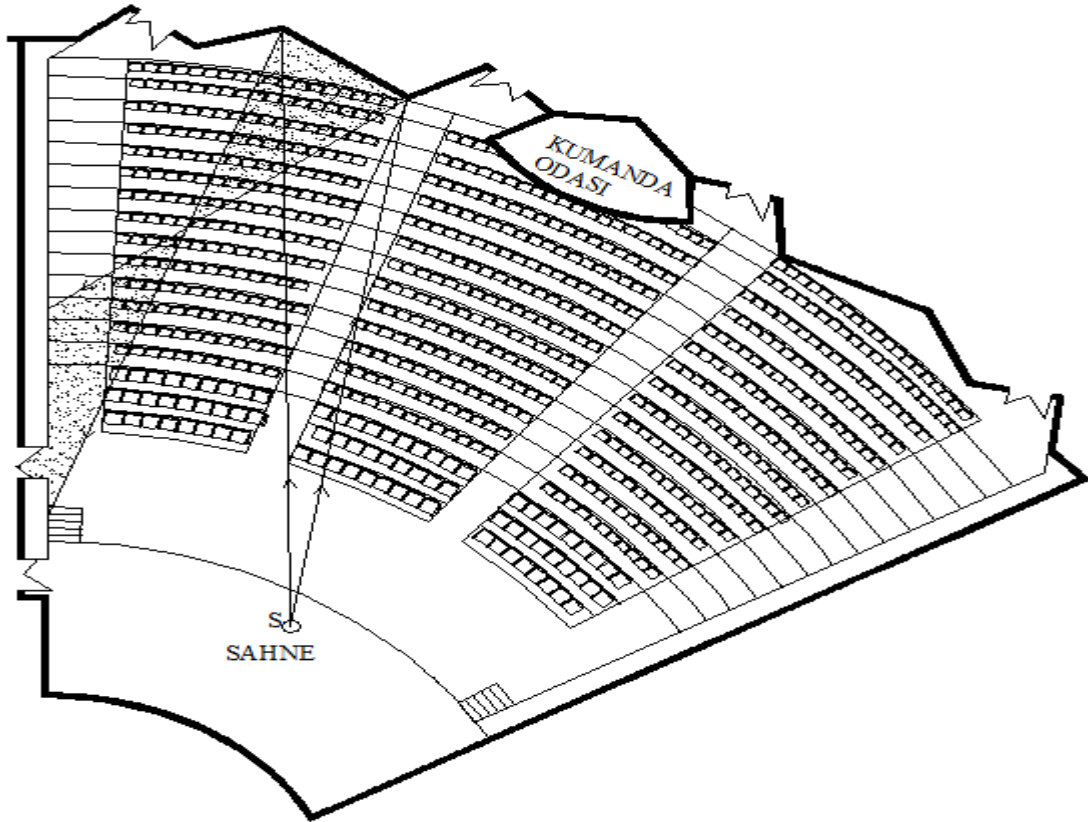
F.Ü. AKM salonu plan üzerinde yapılan değişikliklere göre plan şeması
